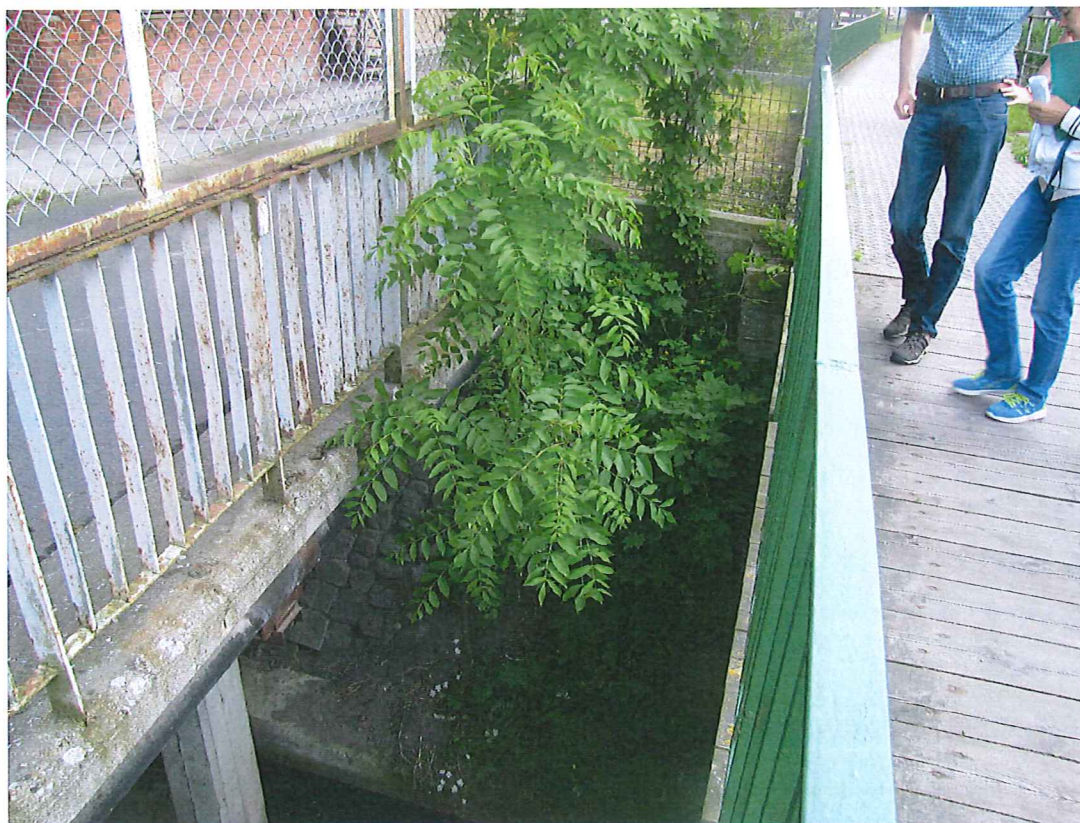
Ubytki korozyjne betonu na górnej powierzchni ścianki zapleczej przyczółka
